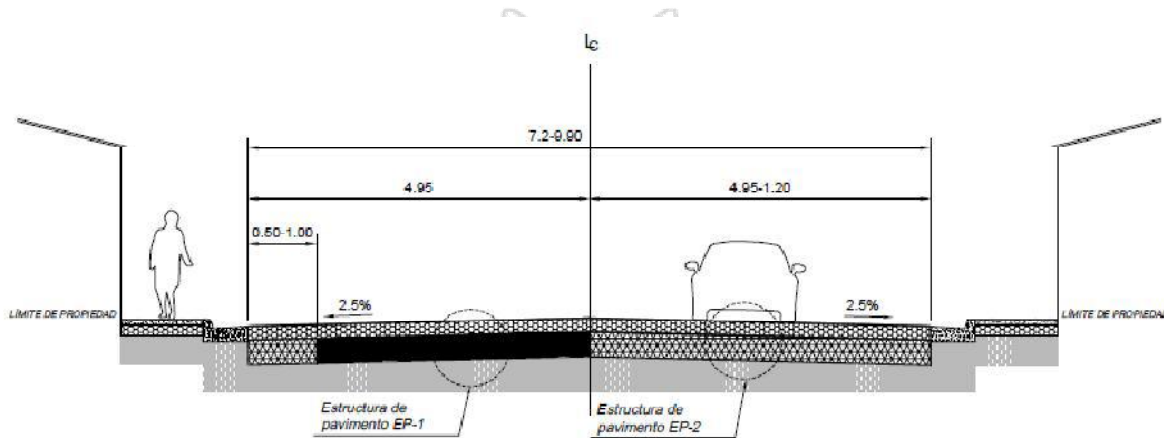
Sección Transversal Tramo 1, Est 0+000 a 0+090.
